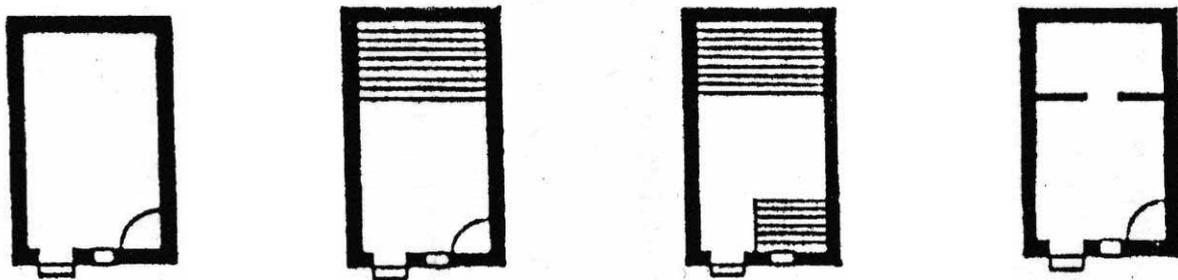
Varianten des schmalfrontigen Hauses: Grundriss-Schemata
